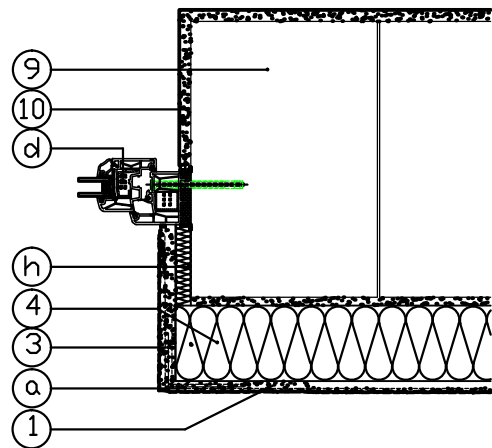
DETAIL UKONČENIA U SOKLA (REZ) M 1:10
